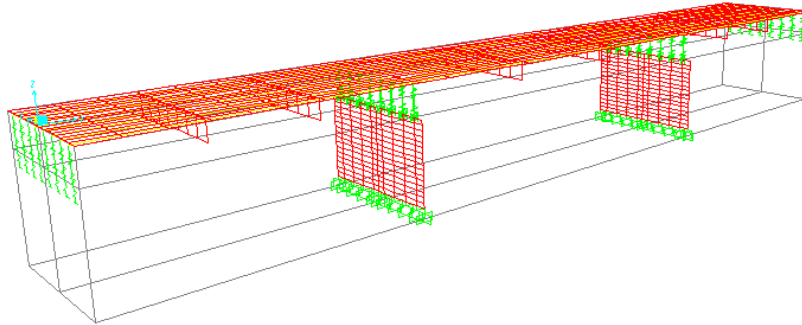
Modelo analítico del Puente Copándaro II con pilas tipo muro modelado utilizando la herramienta “Bridge Wizard”, 3D (SAP2000).
